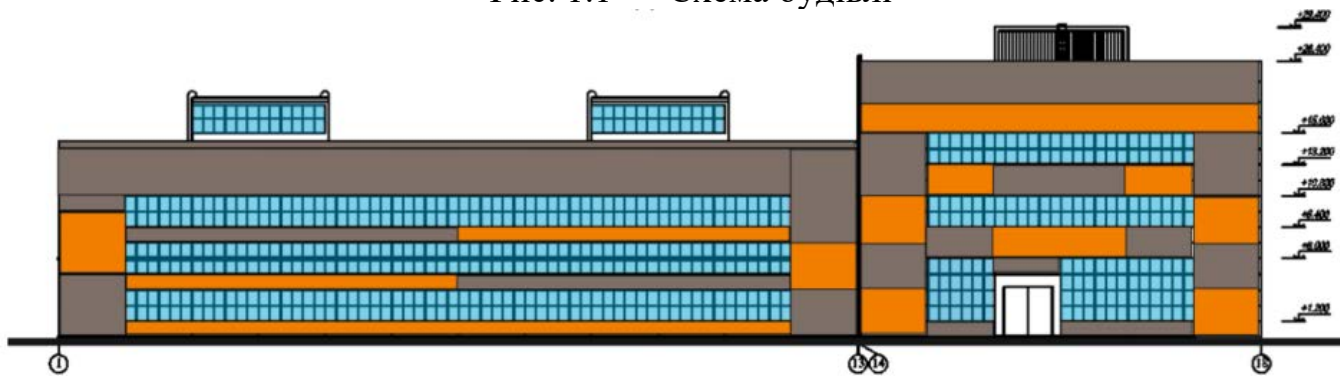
Схема розташування стінових панелей фасаду 1-18
